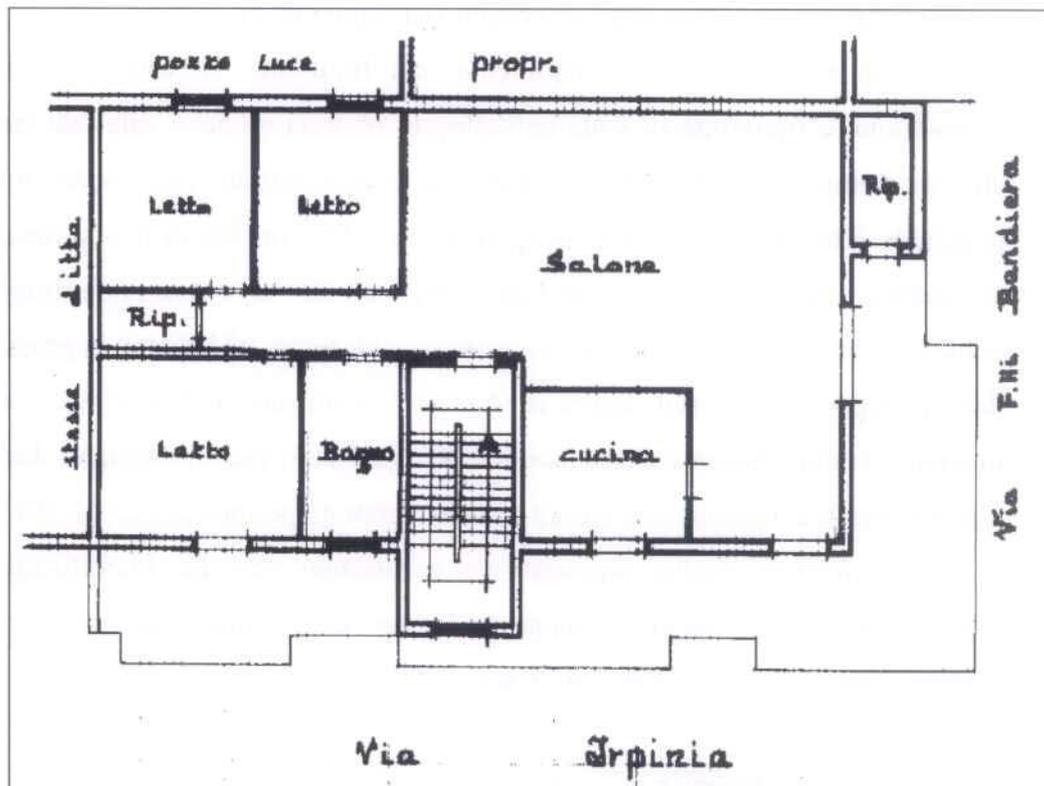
Planimetria catastale dell'appartamento ubicato in via Irpinia n° 6/B piano secondo, interno 2.
